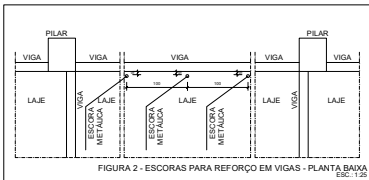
ESCORAS PARA REFORÇO EM VIGAS - PLANTA BAIXA ESC. 1:25
